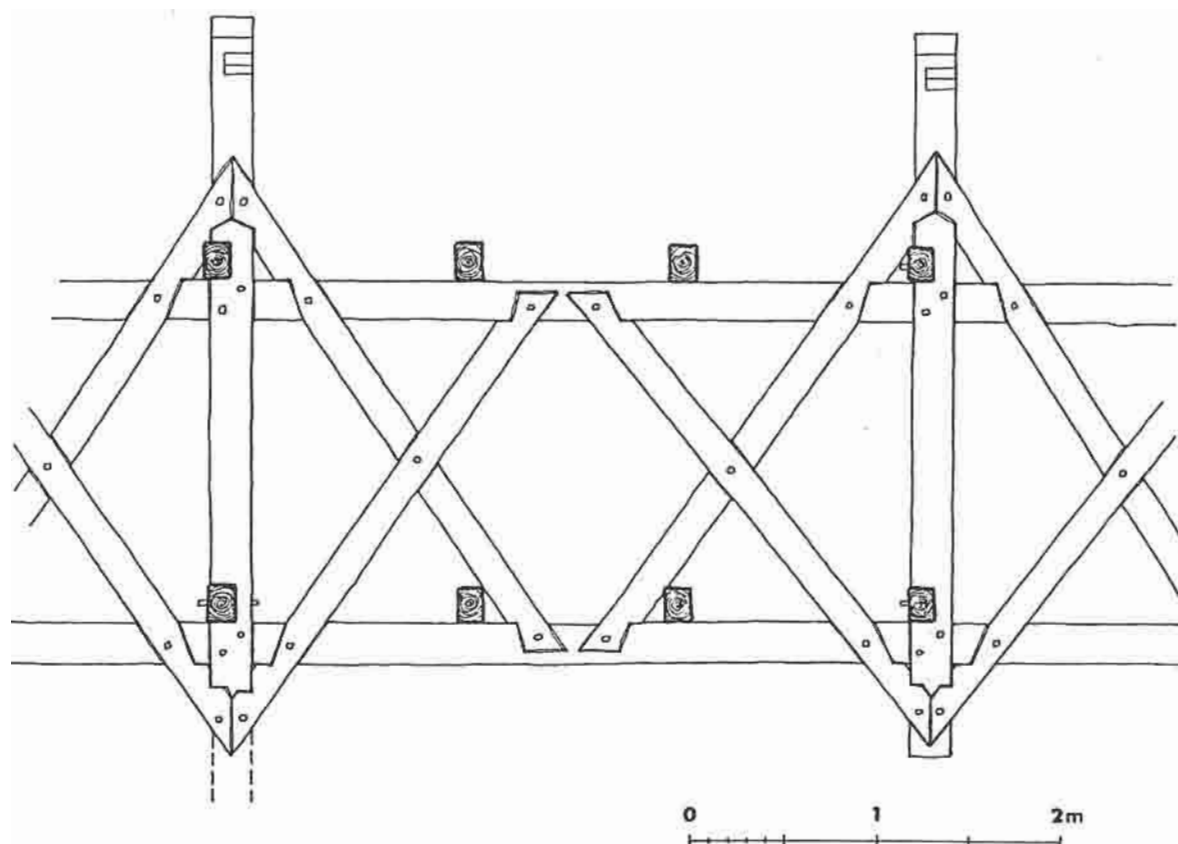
Útěchovice - trosky věšadlového krovu se sloupkem plné vazby a úseky vazníku s ondřejskými kříži. - Útěchovice - remains of the truss construction with a column of the full binding and with sections of a tie-beam with St. Andrew's crosses.
